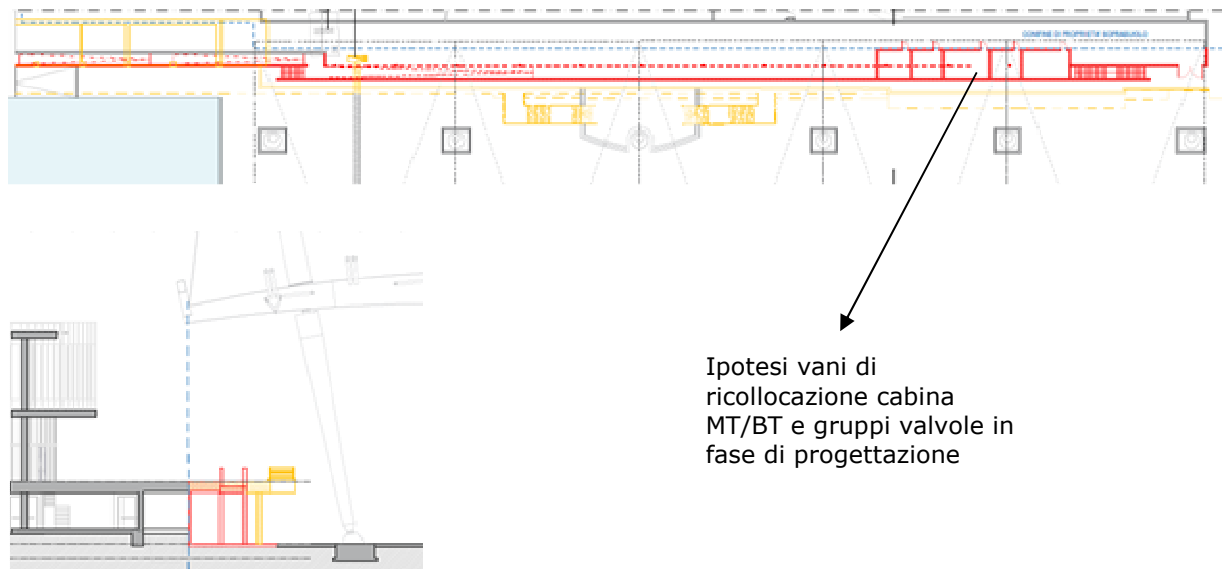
Planimetria e sezione di una possibile configurazione finale attualmente in fase di progettazione
